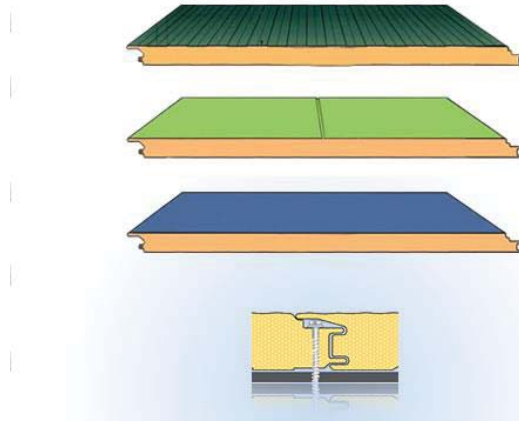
Panel tipo sándwich de fachadas y detalle de unión mediante tornillo roscado oculto.
